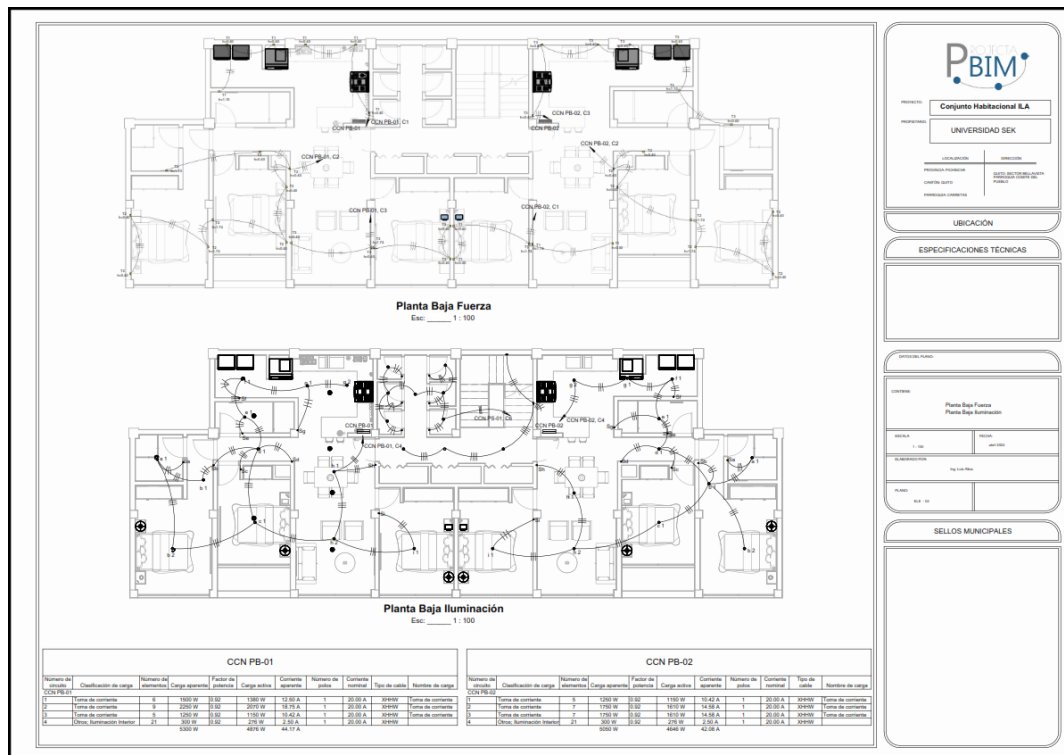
Plano Eléctrico Fuerza e Iluminación Planta Baja B1
